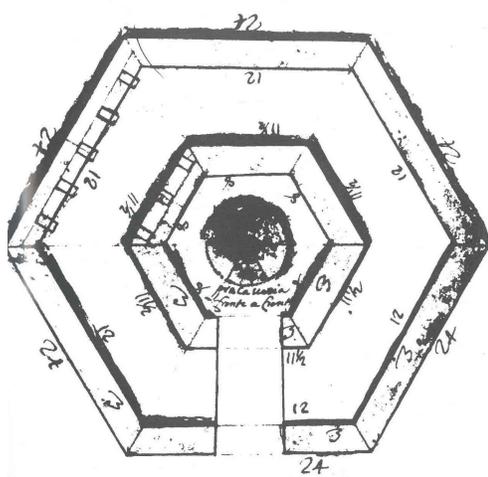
Castelo do Mar, Forte da Lage, da Barra ou do Picão – em planta. Fonte: Albuquerque (1999, p. 33).
